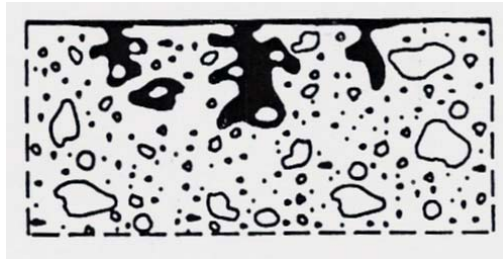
Nanos cementne malte ali betona na obstoječo površino
